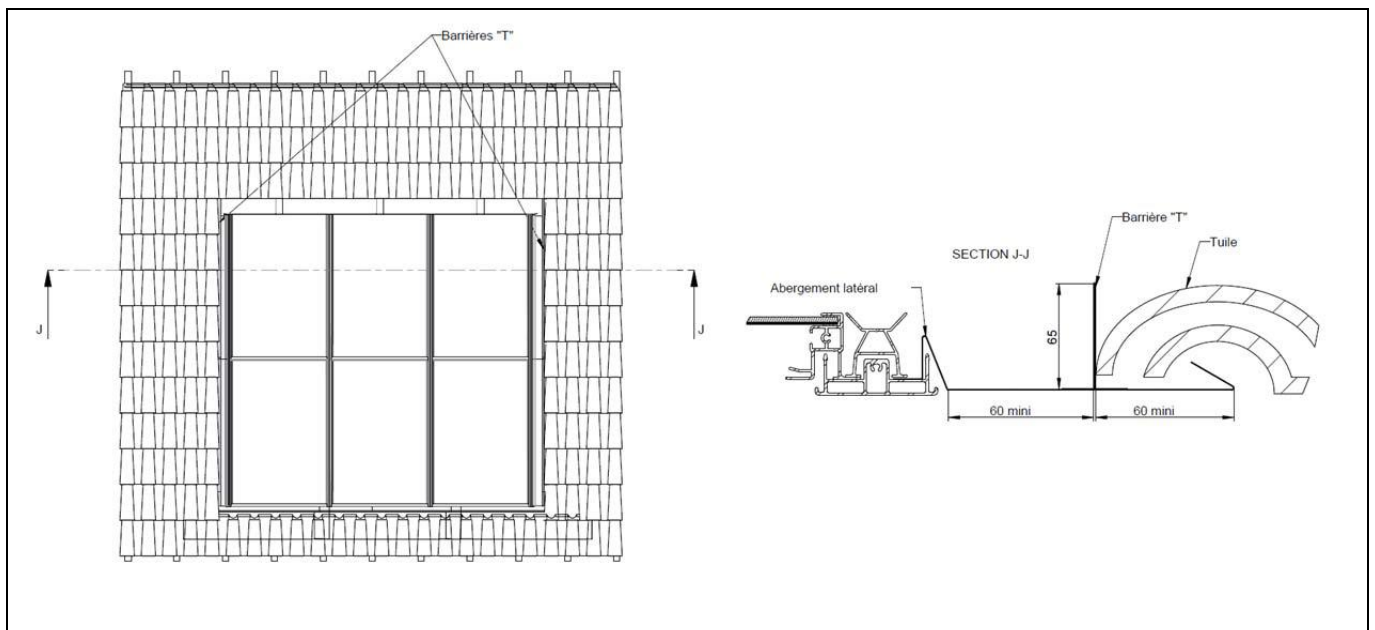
Pose des barrières « T » pour installation sur toiture tuile
